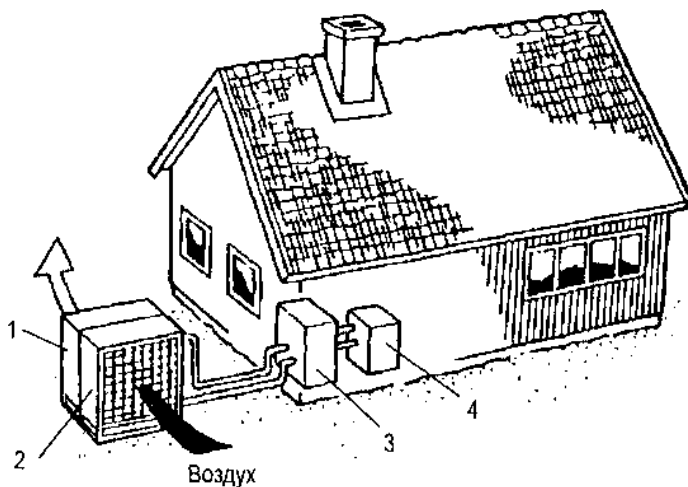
Схема системы с тепловым насосом, использующим тепло наружного воздуха: 1 — вентилятор; 2 — теплообменник; 3 — тепловой насос; 4 — нагреватель воды
